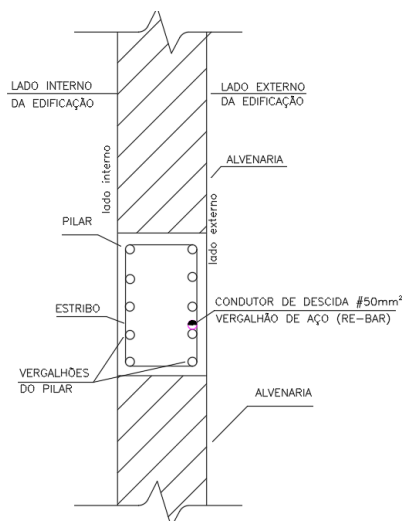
Posicionamento do condutor RE BAR imerso no concreto armado dos pilares.
